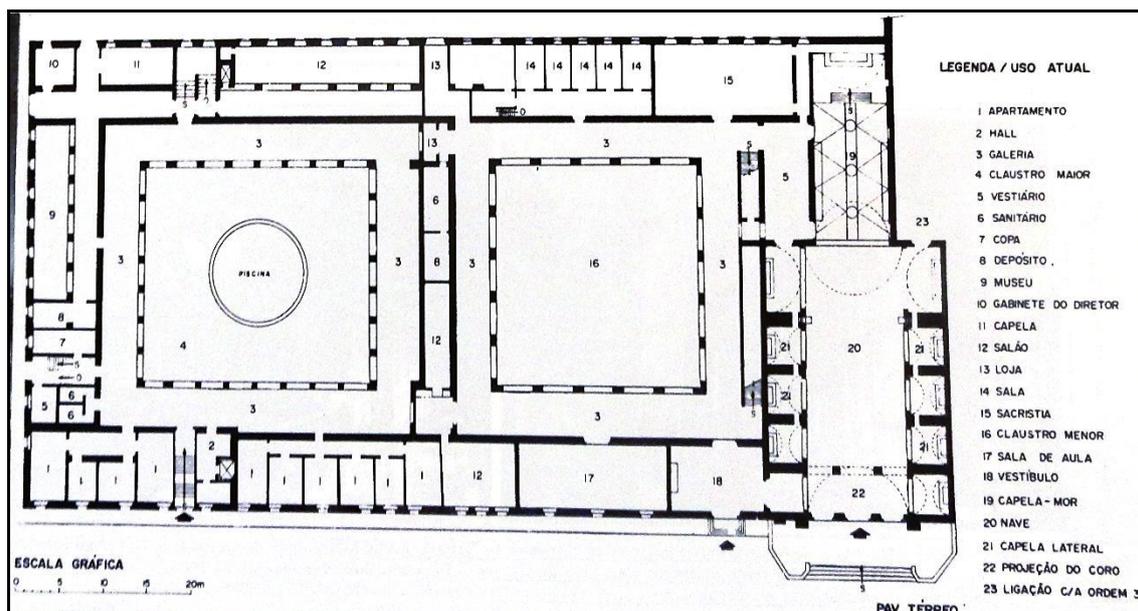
Planta do Convento do Carmo de Salvador da Bahia.
